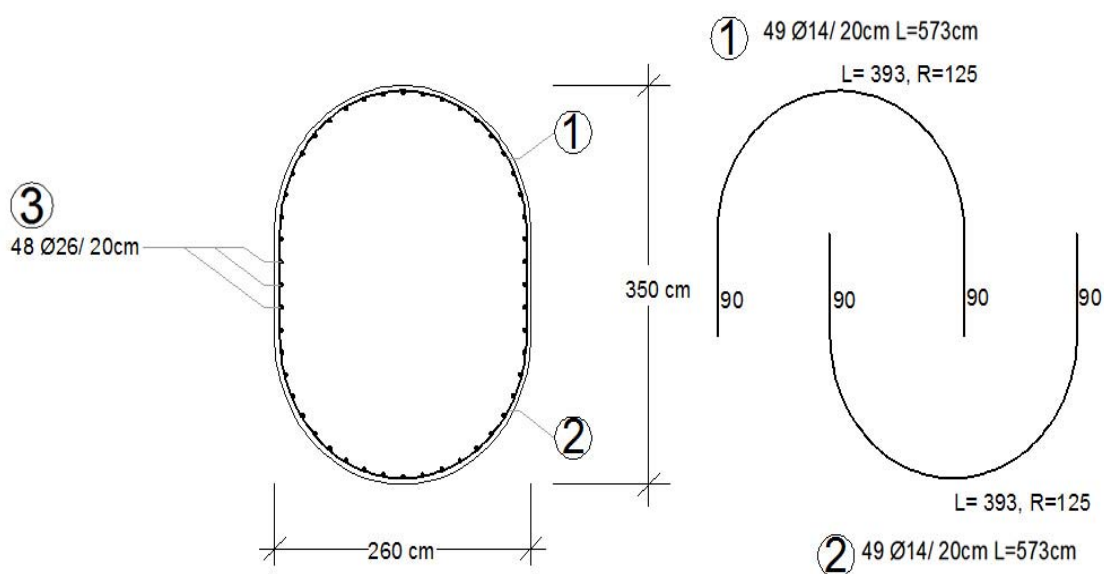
Sezione trasversale pila 2, schema isolato trasversalmente.
